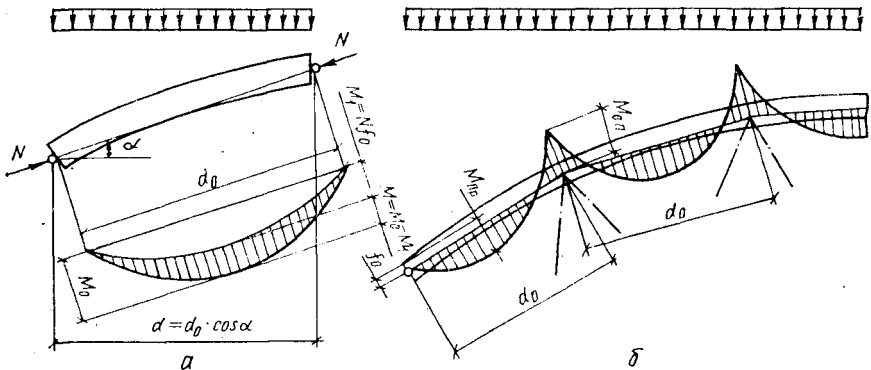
Расчетная схема изгибающих моментов в верхнем поясе сегментной фермы:
